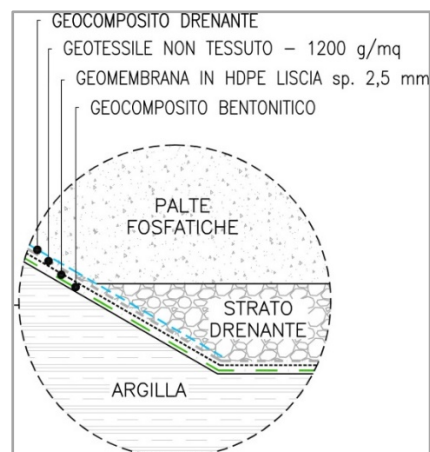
Sistema di impermeabilizzazione delle sponde.
